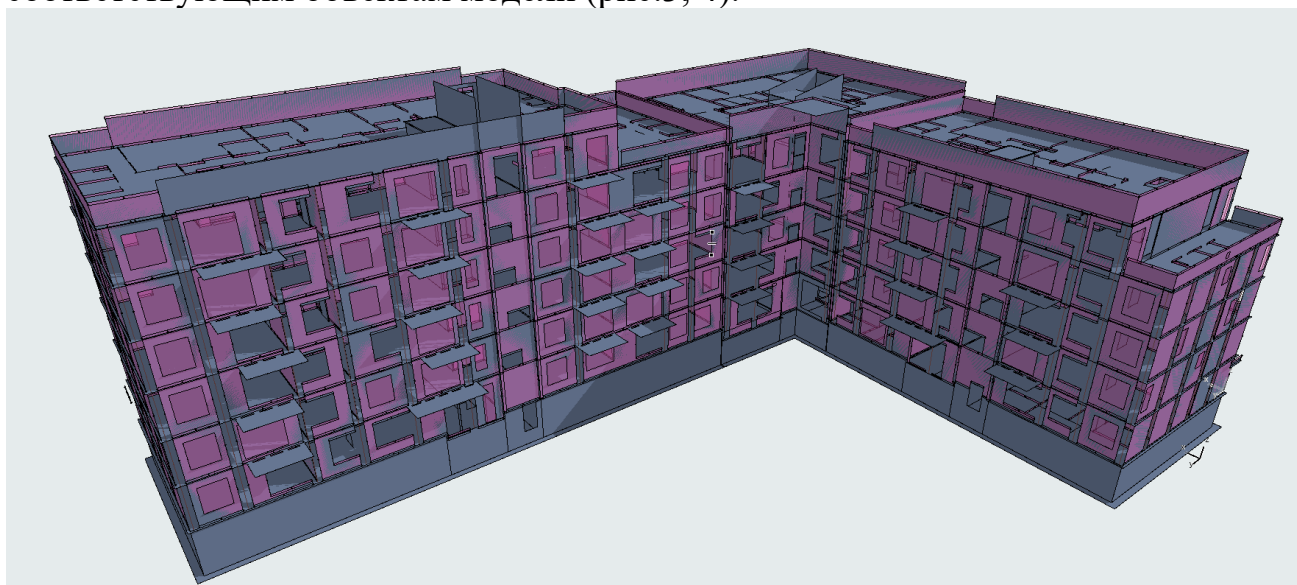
Нагрузки от поэтажно опертых стен и перегородок в ArchiCaD 27
